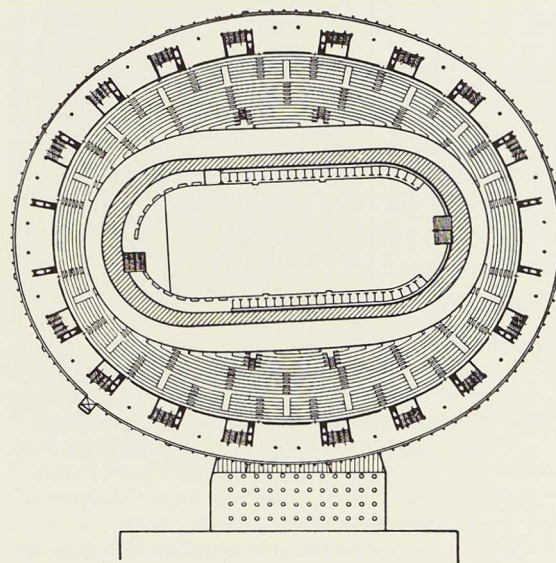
Plan d'implantation du nouveau Hall de Westphalie.
